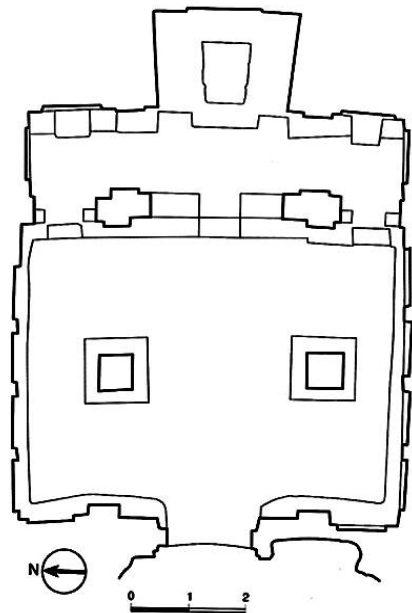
Chiesa rupestre di San Nicola: planimetria.
